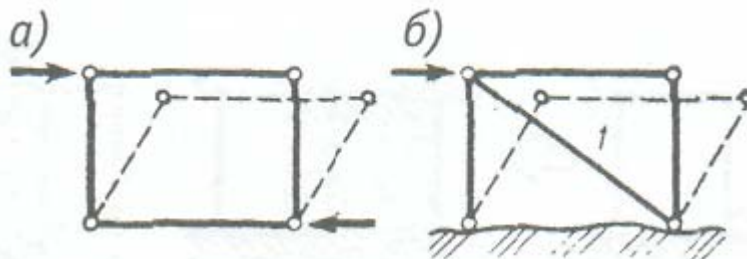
Схема устойчивой работы здания на ветровую нагрузку:
